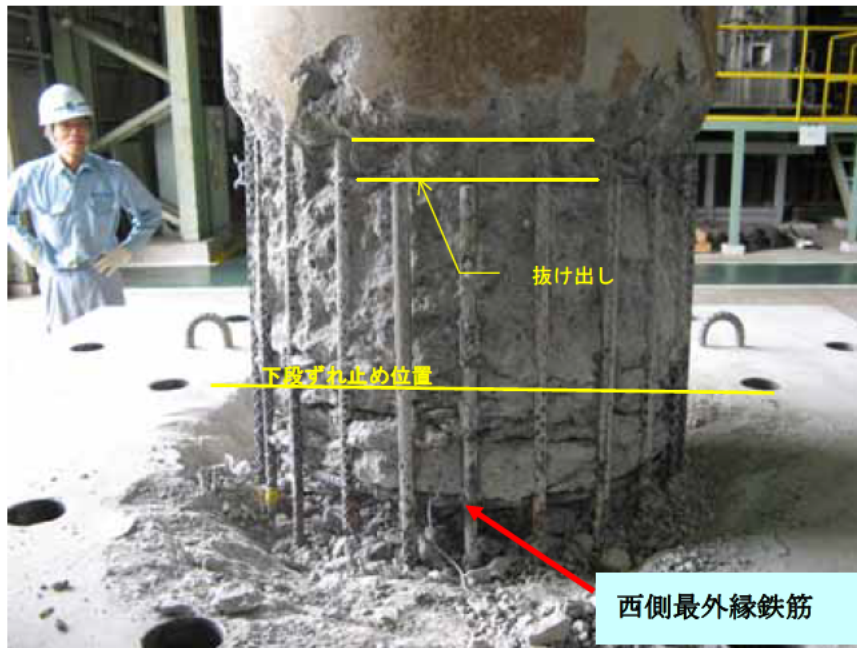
中詰め補強鉄筋の周りのコンクリートを全てはつり出した状況
